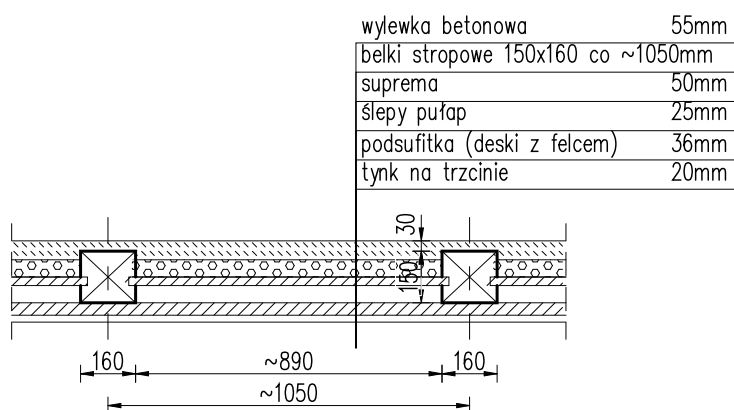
Detal stropu nad piętrem (odkrywka ST-1)
